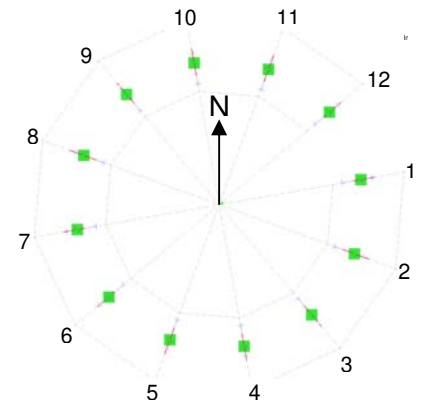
Grundriss Stützenstellung und Systemachsen
